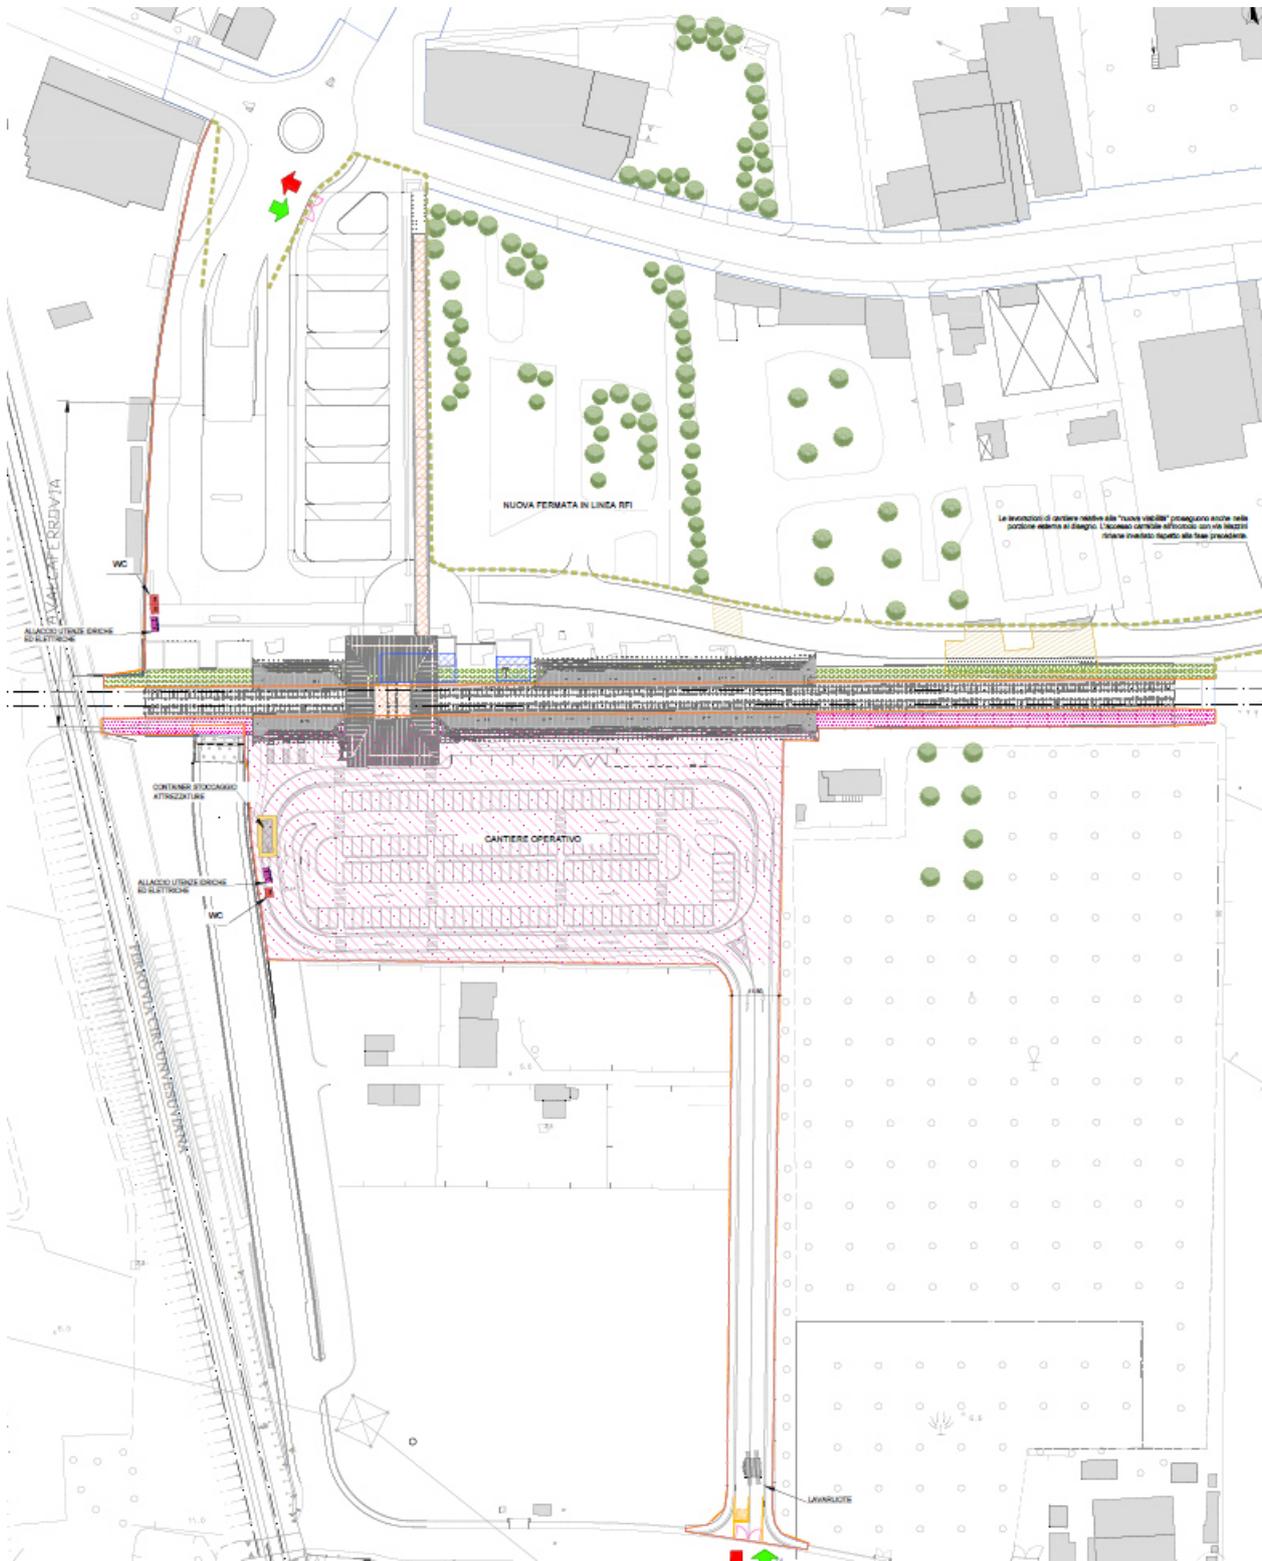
FASE 2b – Lato Ingresso scavi Piazza Esedra
